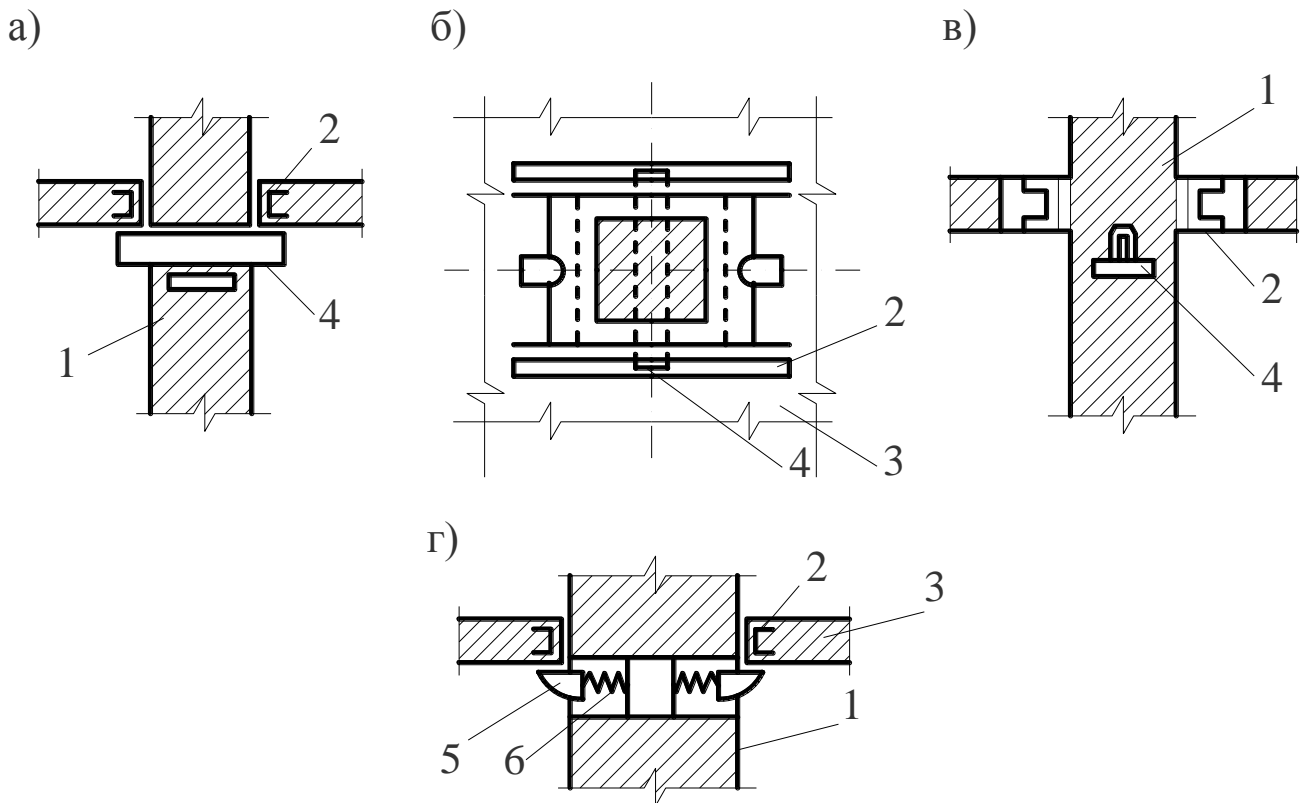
Вузол кріплення плит перекриття на колоні:
